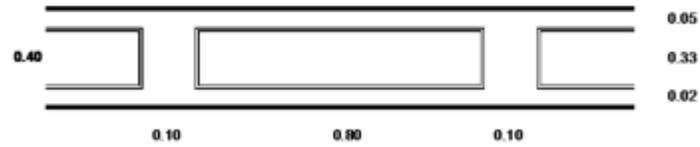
Análisis de cargas de la estructura - Cubierta reunión.
